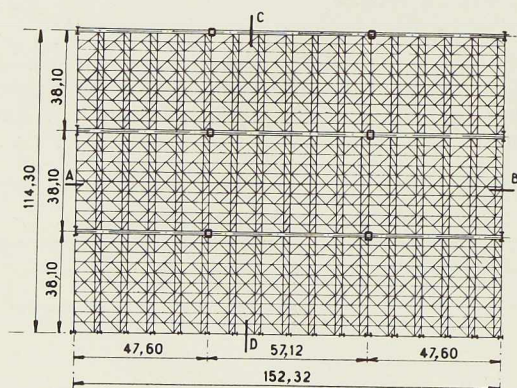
Plan du bloc principal de la nouvelle usine Murex.
